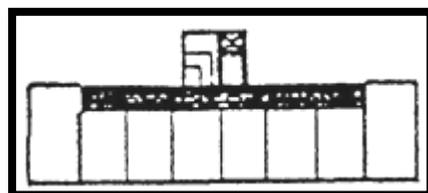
Bentuk Denah *Centre Corridor Plan
